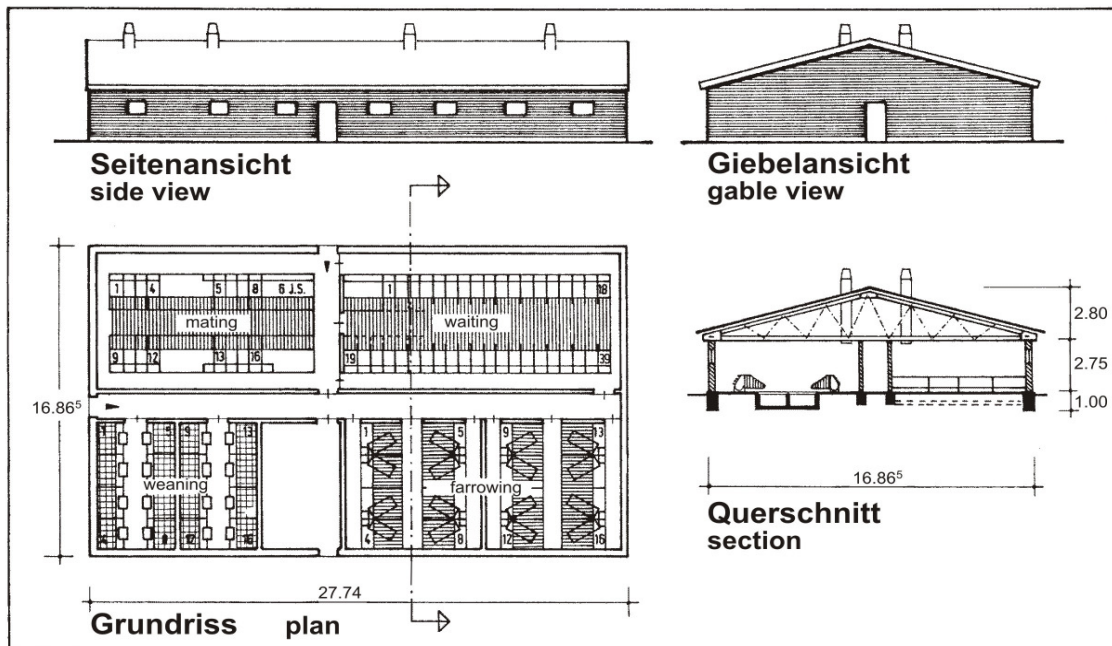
Zuchtschweinestall für 64 produzierende Sauen
